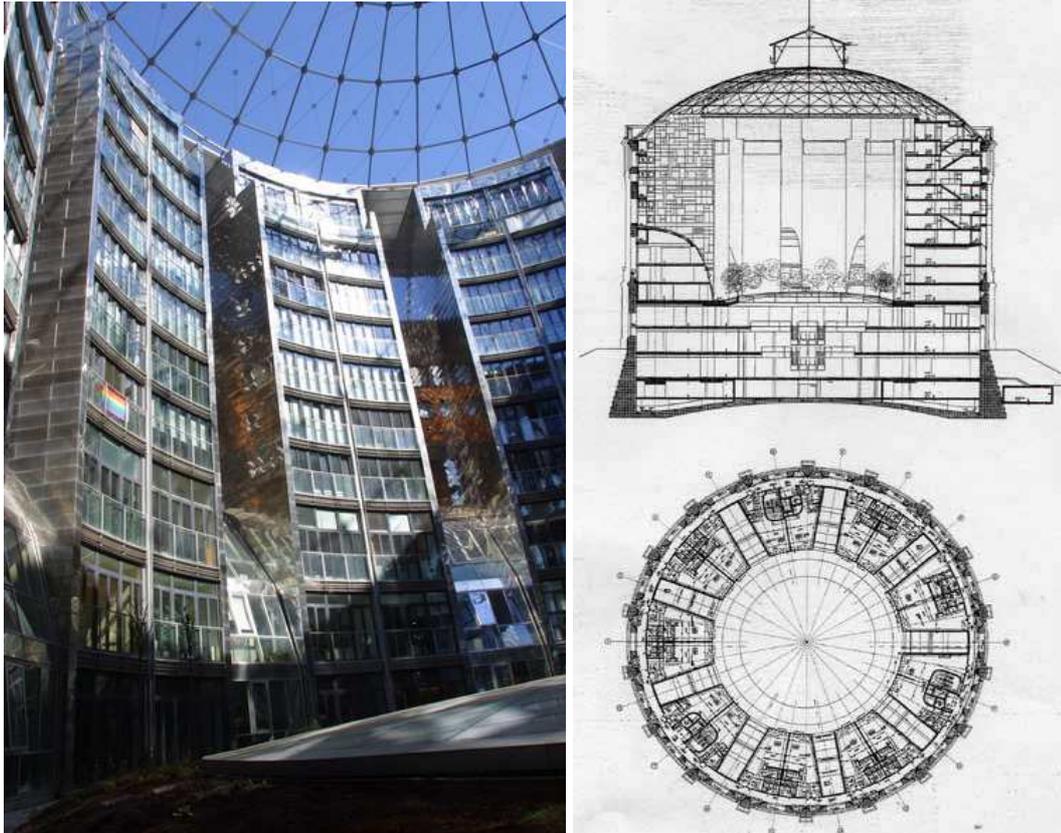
Vista, sezione e pianta tipo del gasometro A adibito prevalentemente ad abitazioni.
